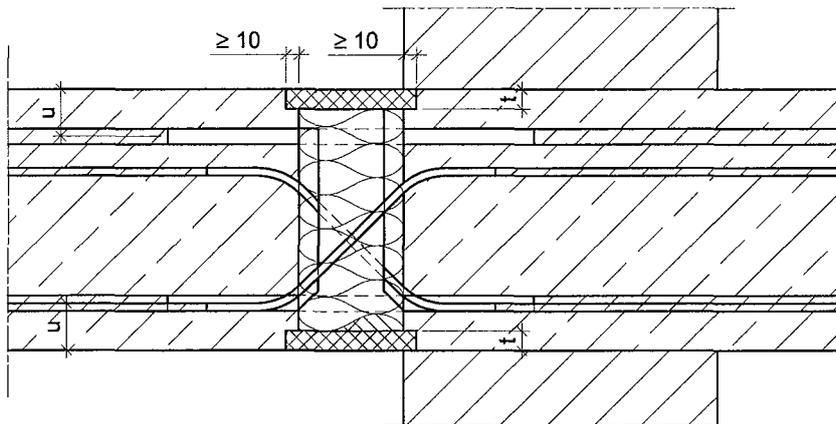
Schöck Isokorb Typ D (F30/F90)
